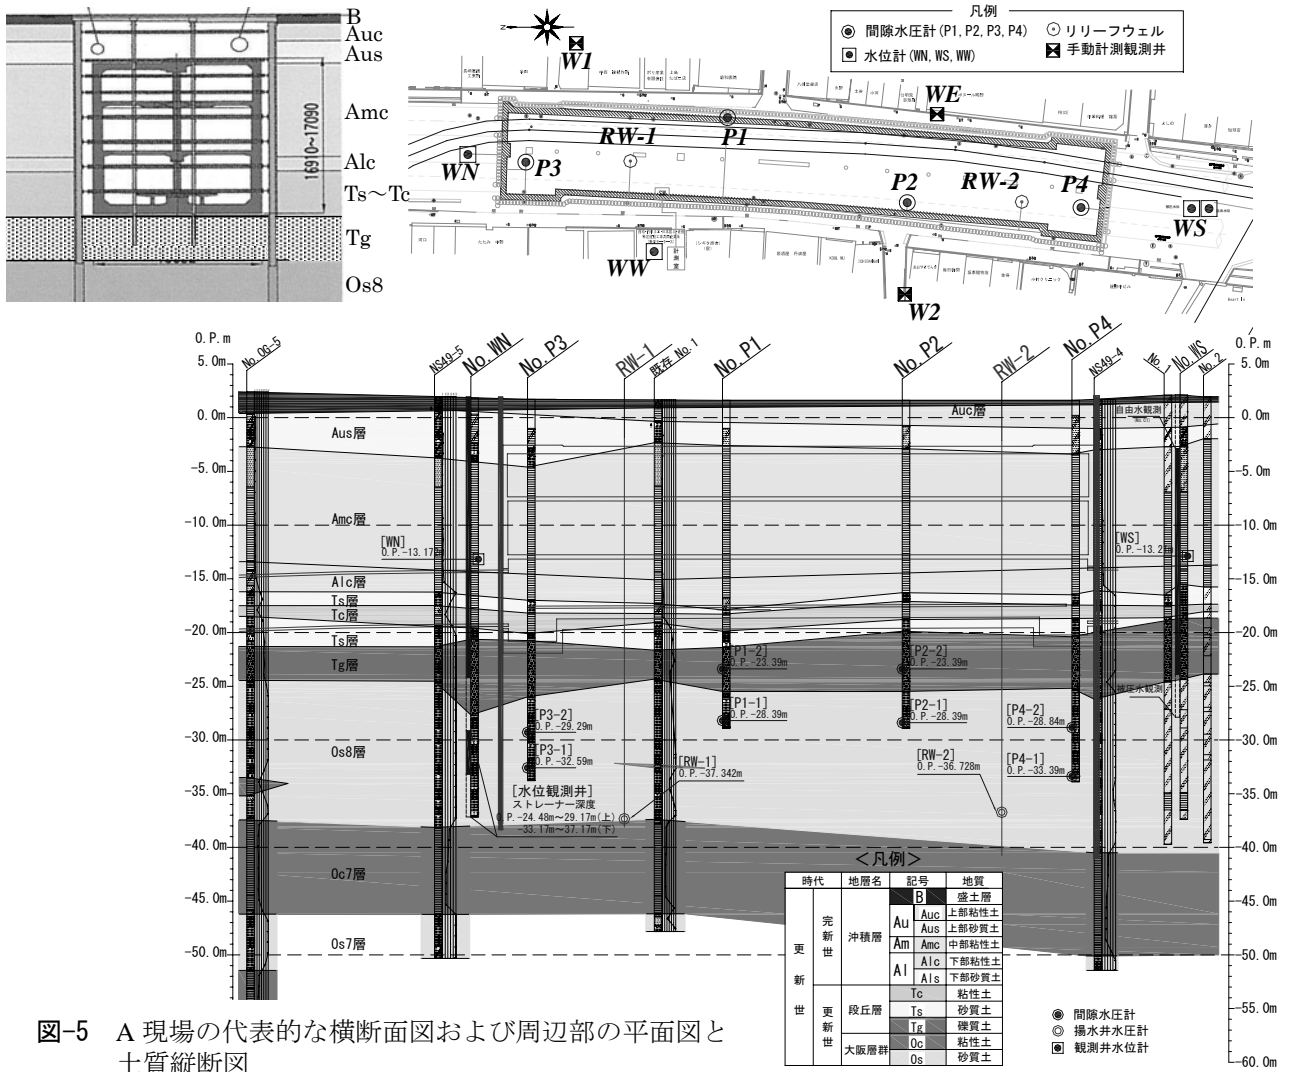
A 現場の代表的な横断面図および周辺部の平面図と土質縦断面図
